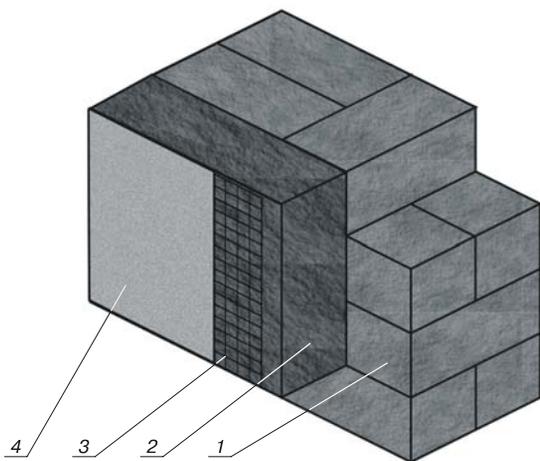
Устройство гидроизоляции ограждающих конструкций: 1 – внутренняя деревянная стена; 2 – «Эволит-термо»; 3 – наружная кирпичная стена
